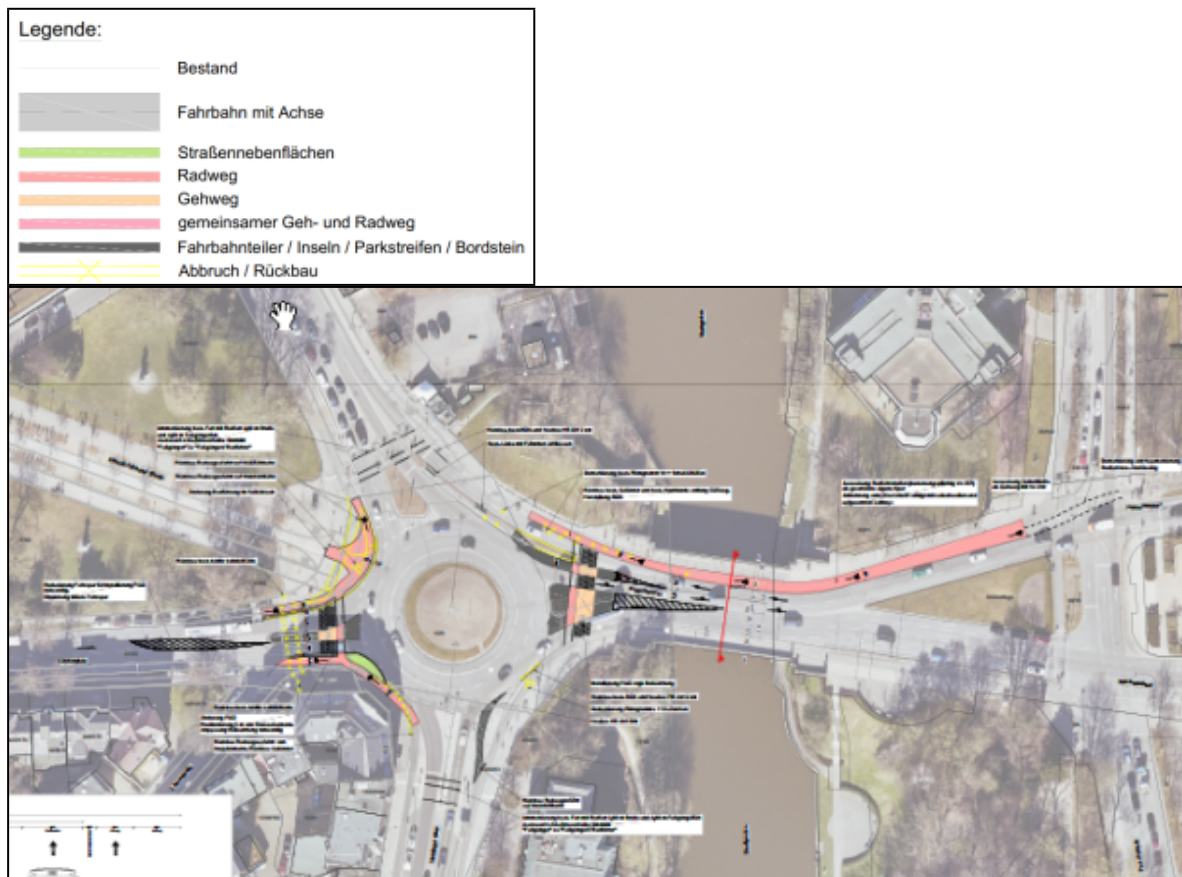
Bestandsnahe Lösung Ausschnitt Lageplan
